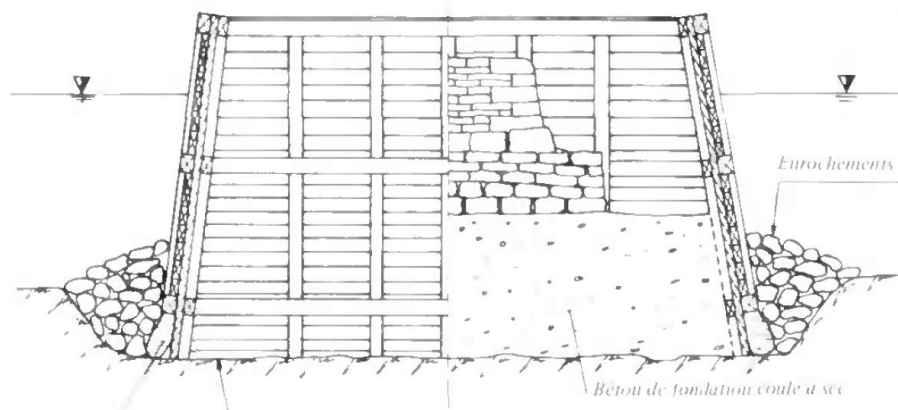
Fondazione su cassone senza fondo: è possibile vedere lateralmente il riempimento in pietrame, in basso a destra il calcestruzzo gettato a secco e lateralmente la tela riempita di argilla. [18]
